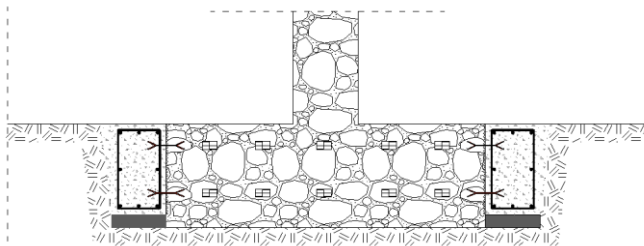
Refuerzo zapapa aislada 1. 2010. Rehabilitar con Acero
